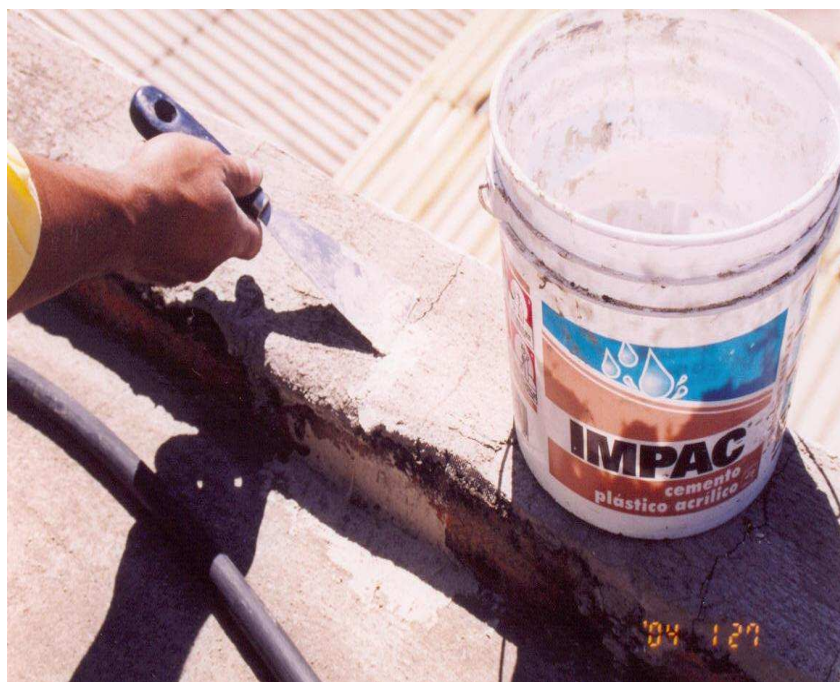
Aplicación de IMPAC CEMENTO PLÁSTICO, en losa fisurada.
